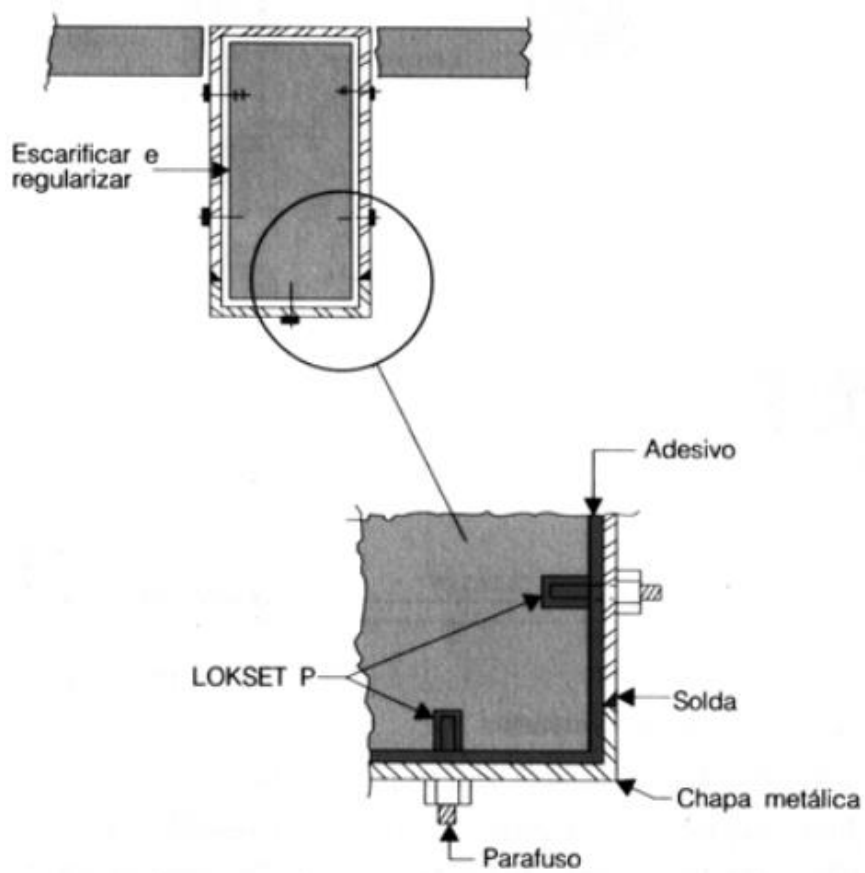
Corte do pormenor do estribo e pormenor da fixação da chapa. (Fernando G., et al 2002)
